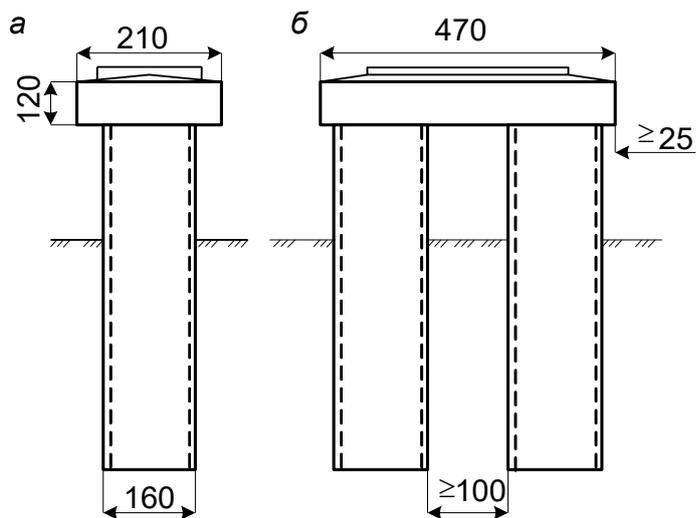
Промежуточная опора безростверкового типа на сваях-оболочках: а – вид вдоль оси моста; б – вид поперек оси моста
